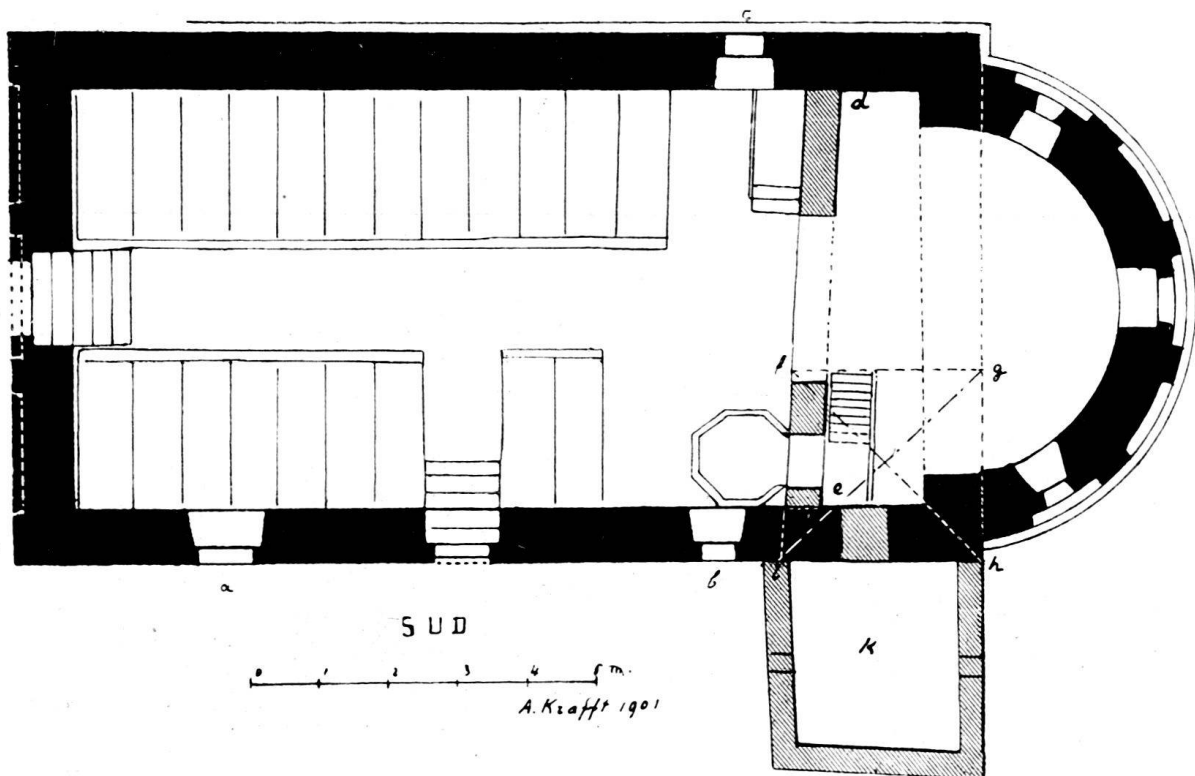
Kirche von Einigen. Grundriss.
